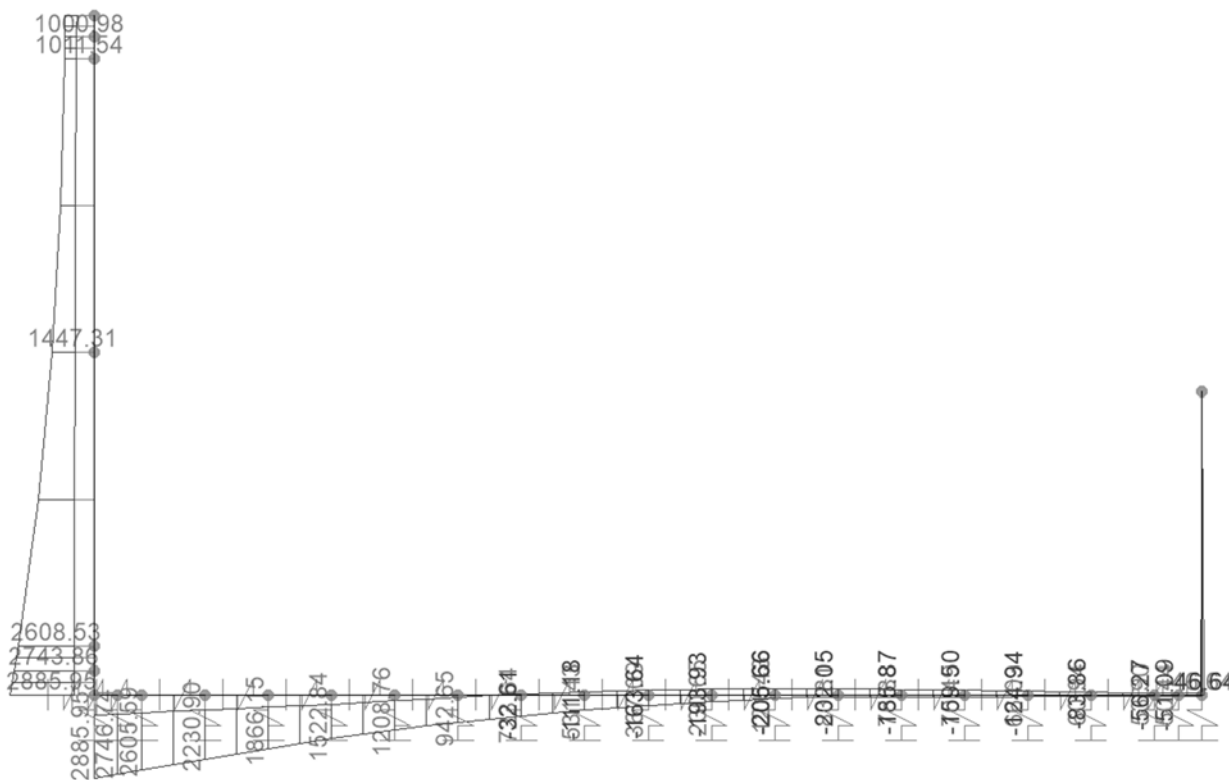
SLV – Piedritto e platea di fondazione – Momenti Med
